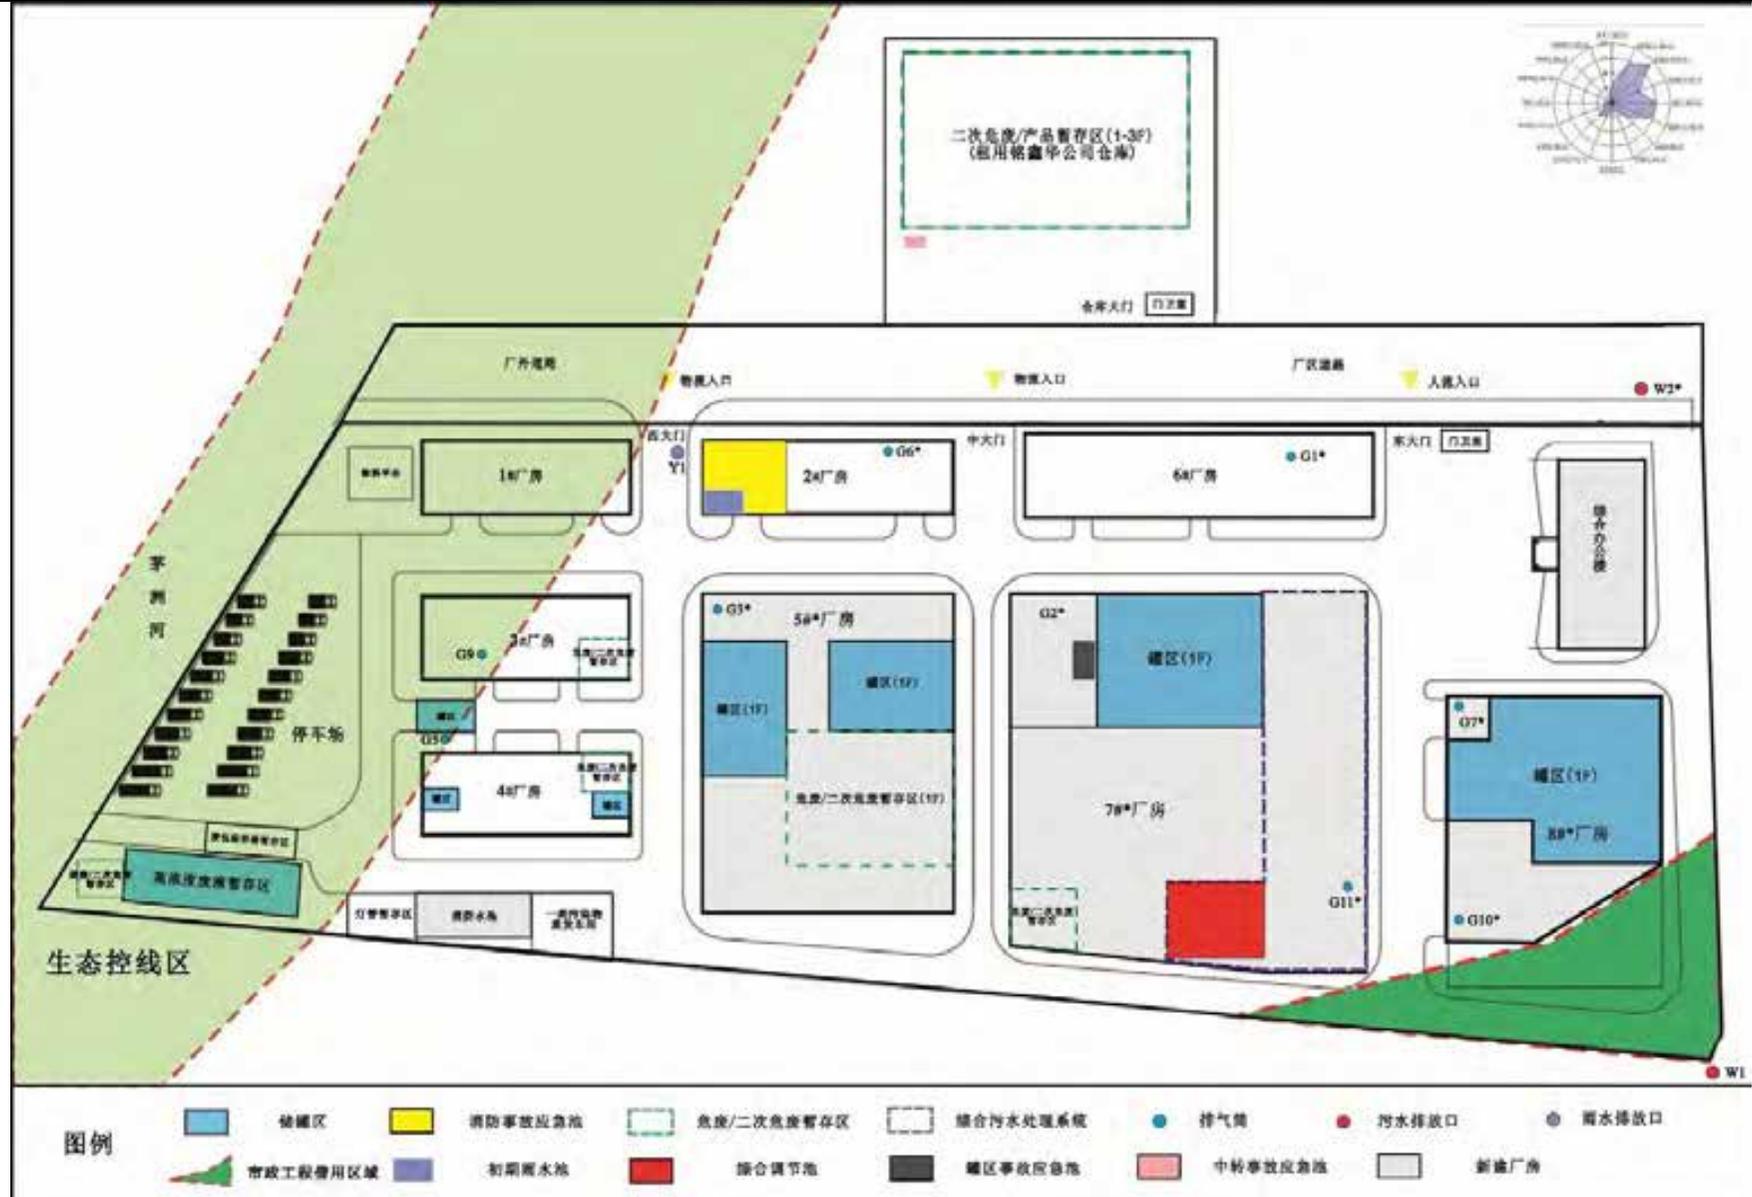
改扩建全部完成后厂区平面布置图（拟新建构筑物一期未新建）
